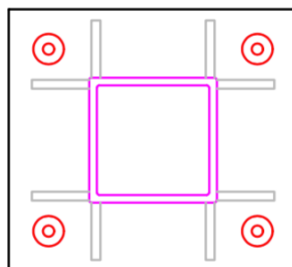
Section carrée avec doubles raidisseurs parallèles aux bords de la platine
